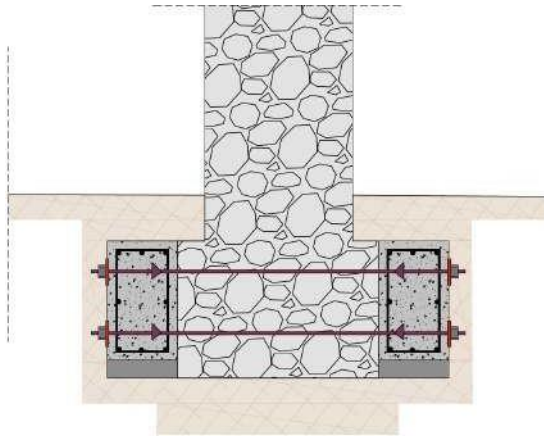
Sección zapata corrida. Refuerzo Tipo 1. Fuente propia
